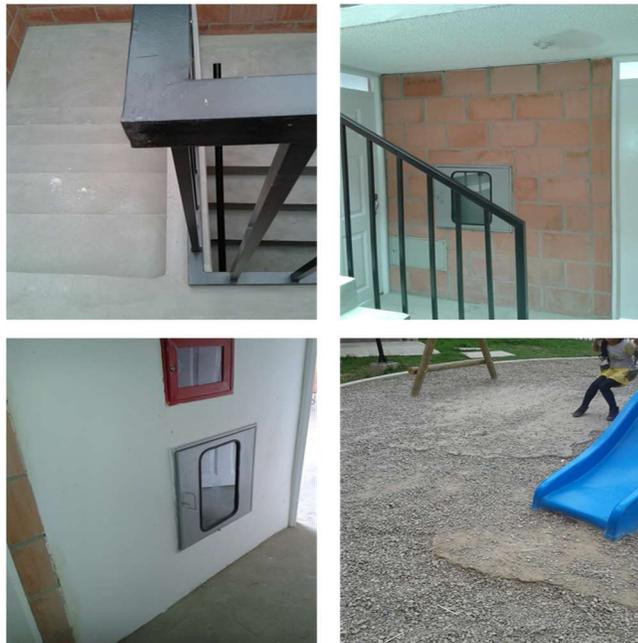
Acabados en puntos fijos torres de apartamentos y parque infantil diseño inicial ejecutado y modificado posteriormente. Archivo Personal. 2014.
